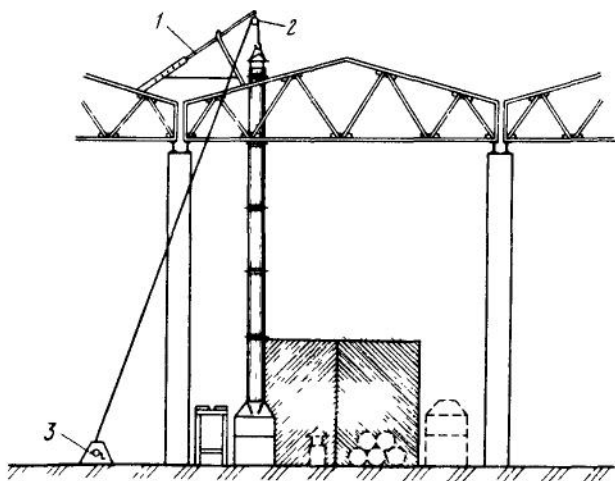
Монтаж вертикальных воздуховодов с использованием треноги и лебедки:
